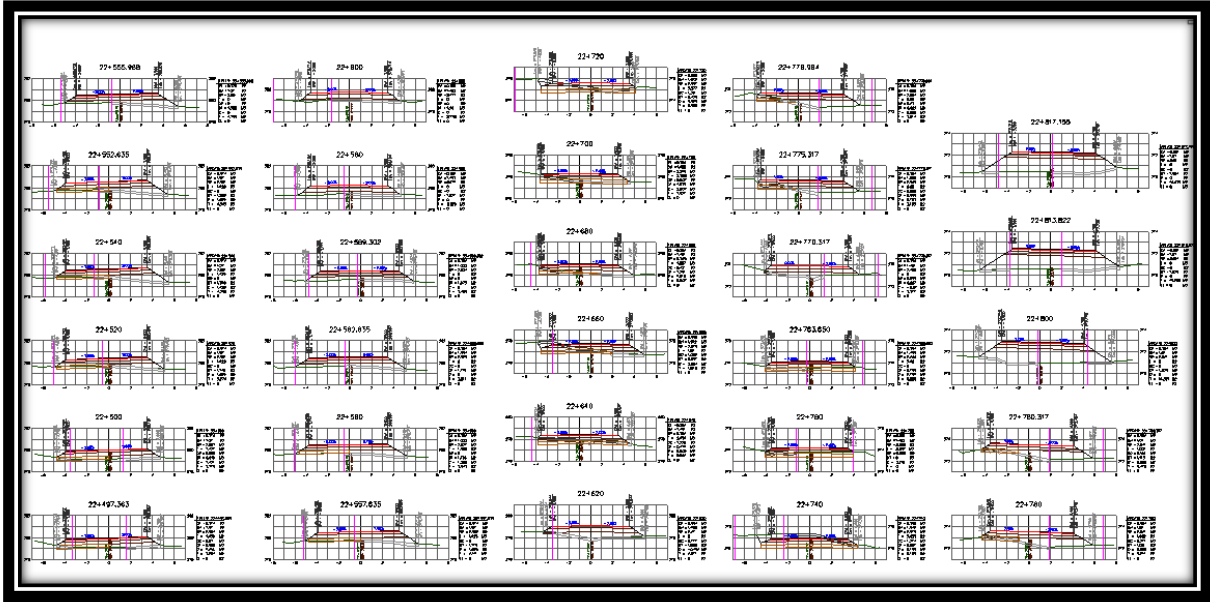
Secciones de construcción del km 22+497.363 al km 22+817.155.
